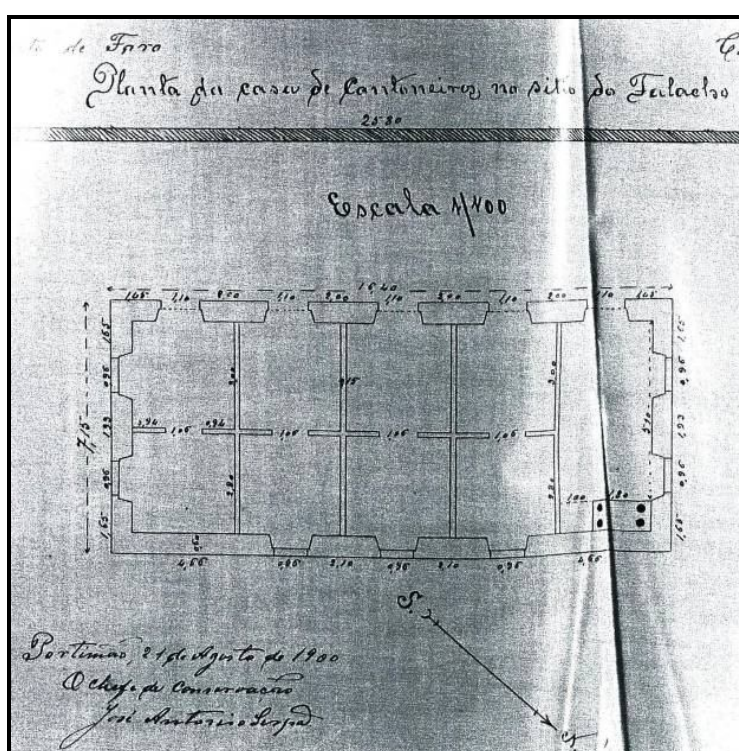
Planta da Casa de Cantoneiros no ditio do Falacho
